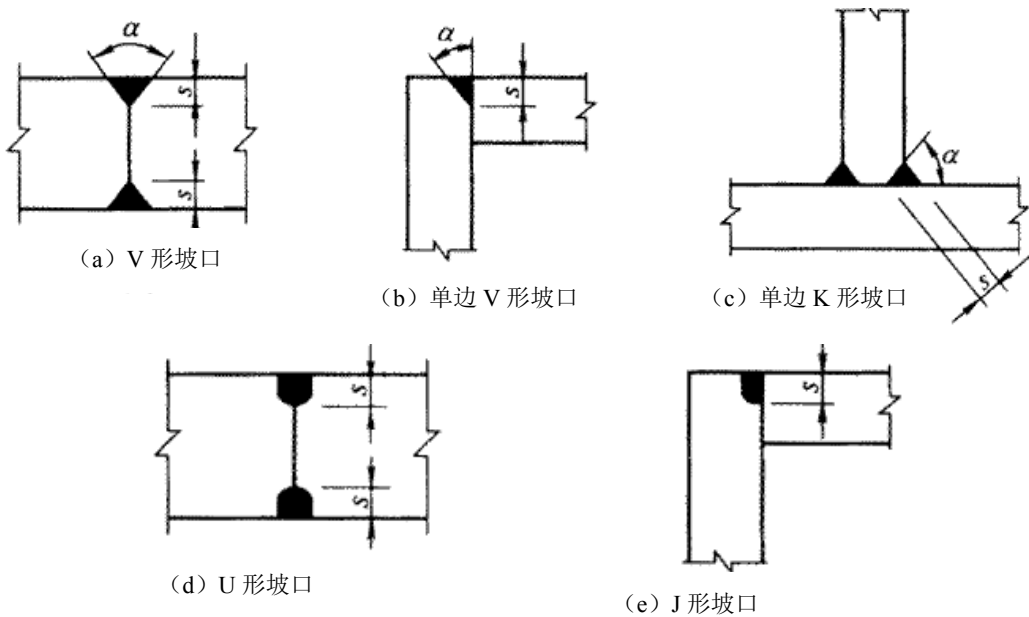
部分熔透的对接焊缝和 T 形对接与角接组合焊缝截面
